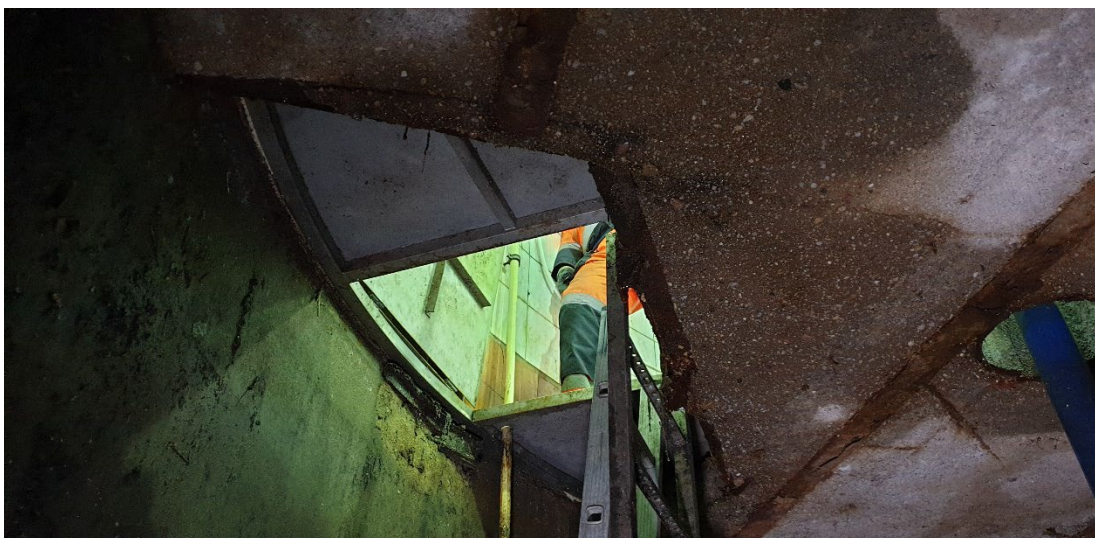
Widok korozji betonu i elementów stalowych na stropie komory czepalnej I
